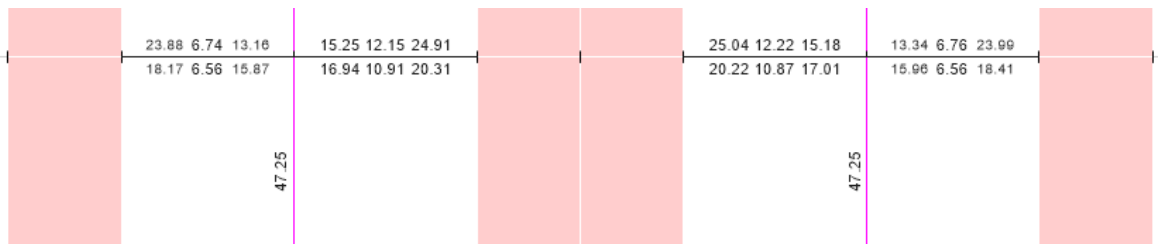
Acero Requerido por momentos en Vigas 3° Piso
